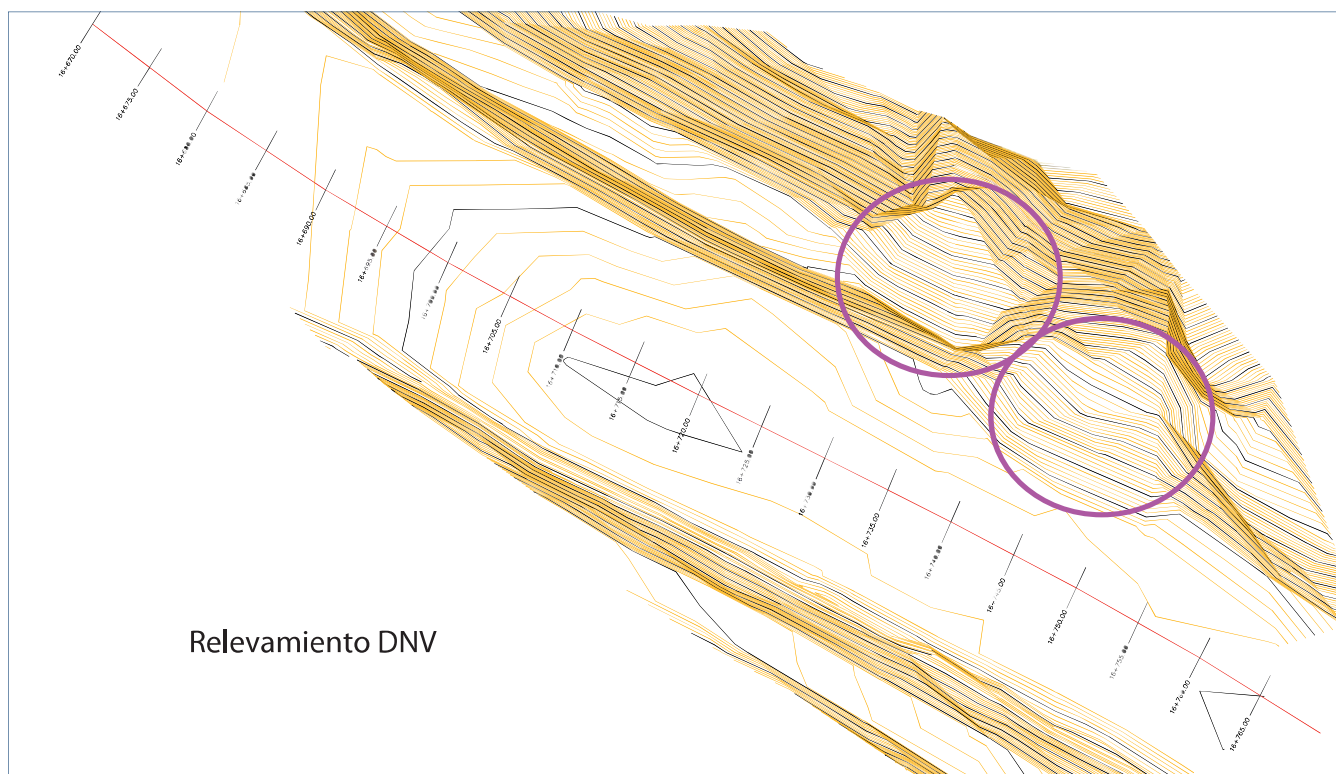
Planta del relevamiento de la zona de trabajo luego de los deslizamientos
